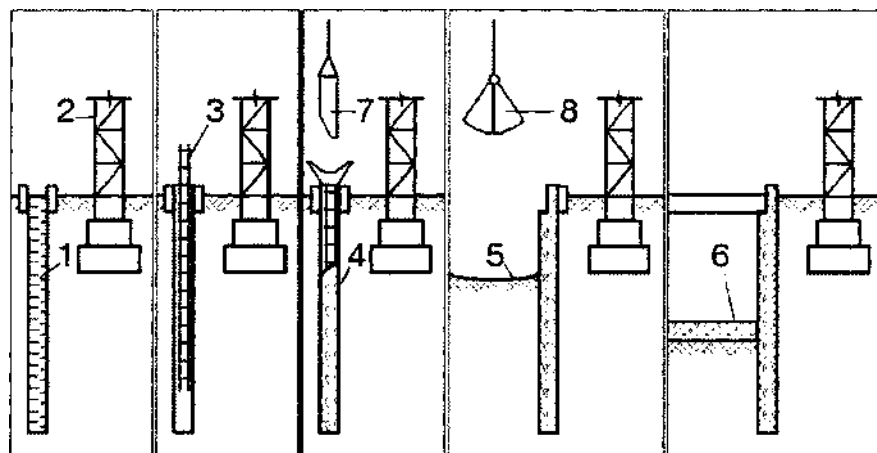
Схема виконання робіт зі зведення конструкцій способом «стіна в ґрунті»: 1 - свердловина; 2 - існуюча будівля, споруда; 3 - установка арматурного каркасу; 4 - бетонування стіни; 5 - забетонована стіна; 6 - установка розпірних балок
